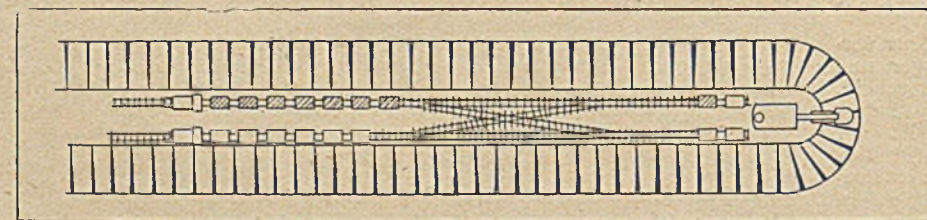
Bagger im Einschnitt, Materialabfuhr hinter dem Bagger.
